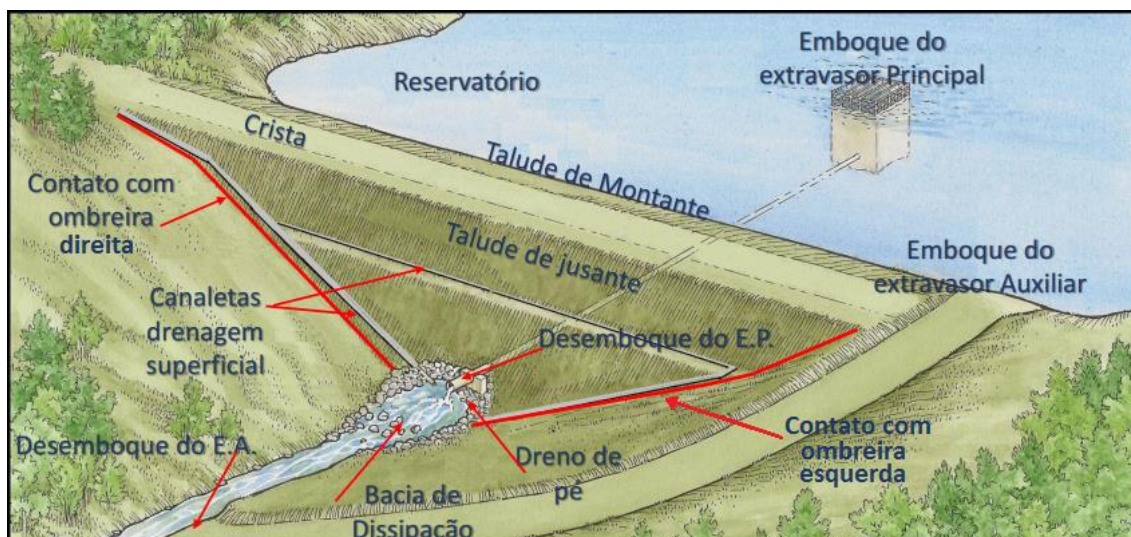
Elementos construtivos de uma barragem. Fonte: Adaptado de *Williams Lake Conservation Company*.
